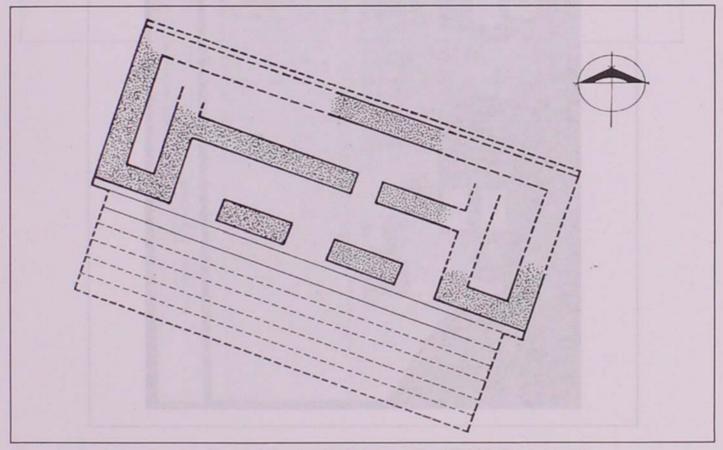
Planta arquitectònica de la Estructura I-A Sub o Templo de los Estucos de Balamkù
